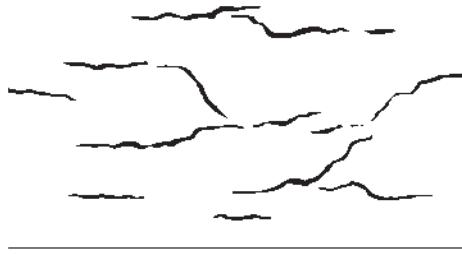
Grietas por contracción plástica (figura modificada de ACI 224.1R, 1993)
